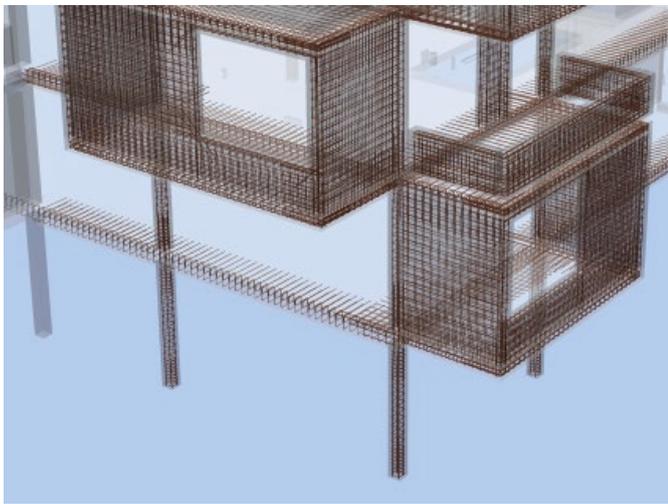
Isometrie Bewehrungsführung im Bereich der Wohnraumerweiterungen
